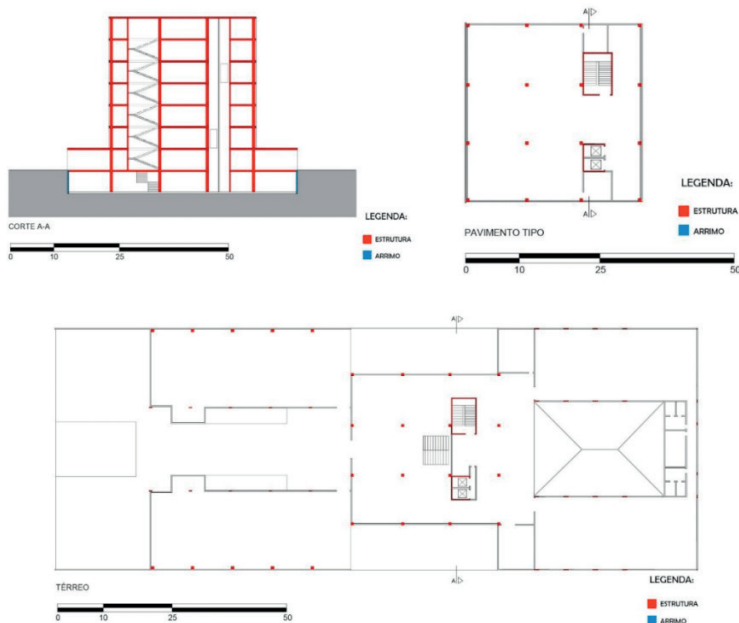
Análises da estrutura em corte, planta do andar tipo e térreo.
